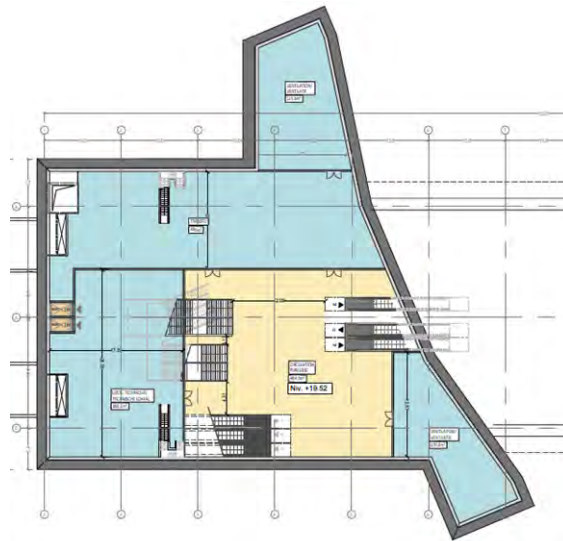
Plan du niveau -2 selon l'alternative bitube (BMN, 2020)
